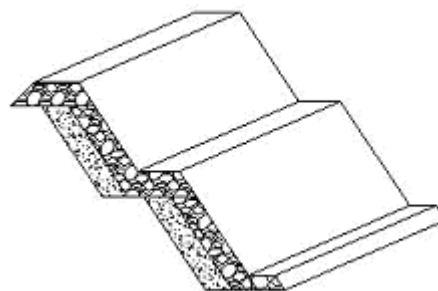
Estrutura longitudinal aderente com secção composta por banqueteta intermédia.
